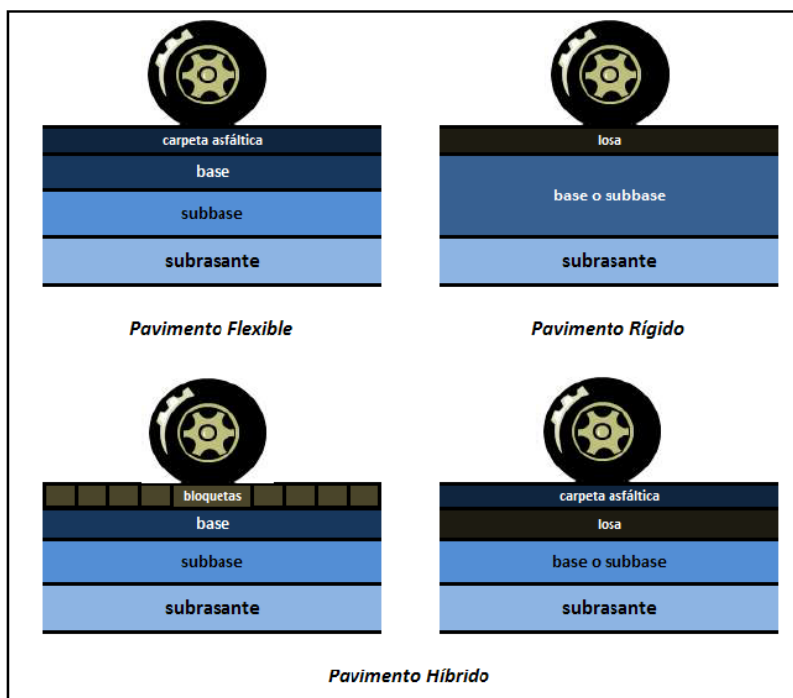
3. Pavimento flexible, rígido e híbrido.
